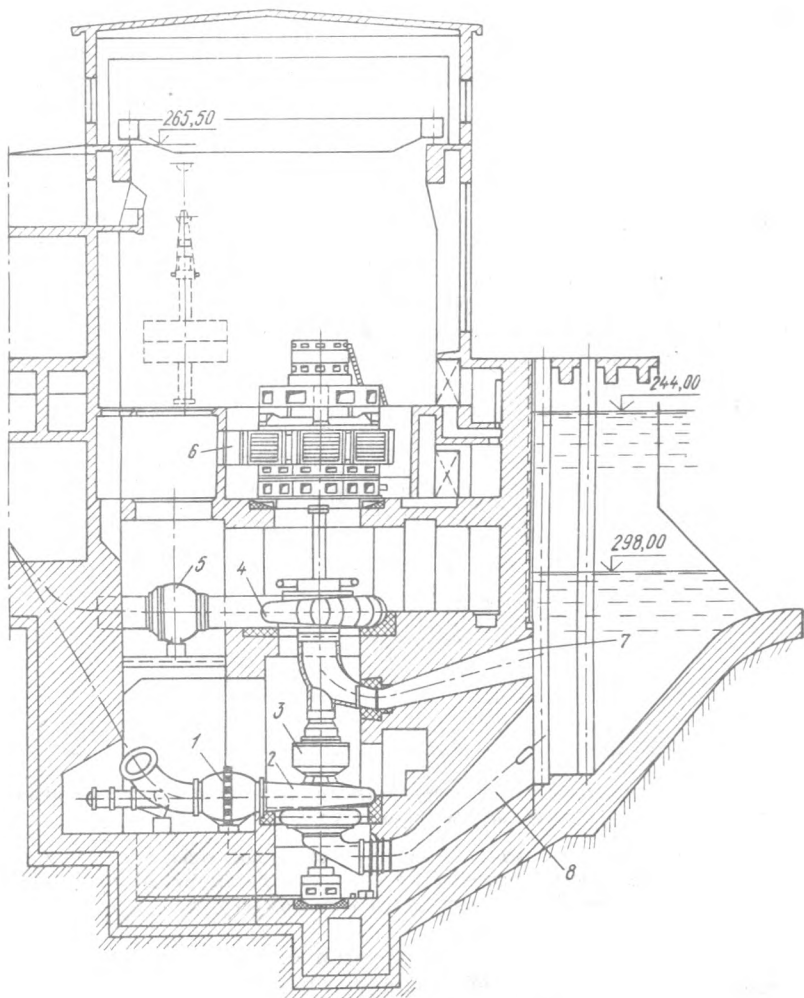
Здание гидроаккумулирующей электростанции, выполненное по двухмашинной схеме с вертикальными агрегатами (поперечный разрез здания Загорской ГАЭС):
